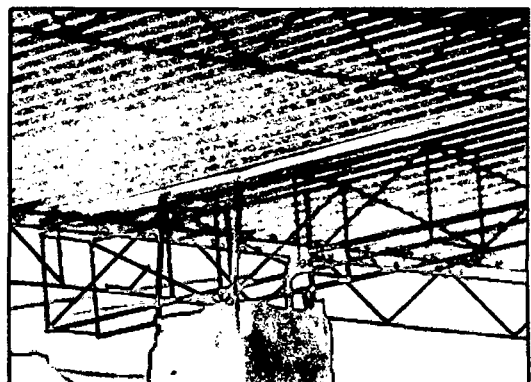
(b). Estructura metálica de la cubierta mal conectada al sistema resistente.
